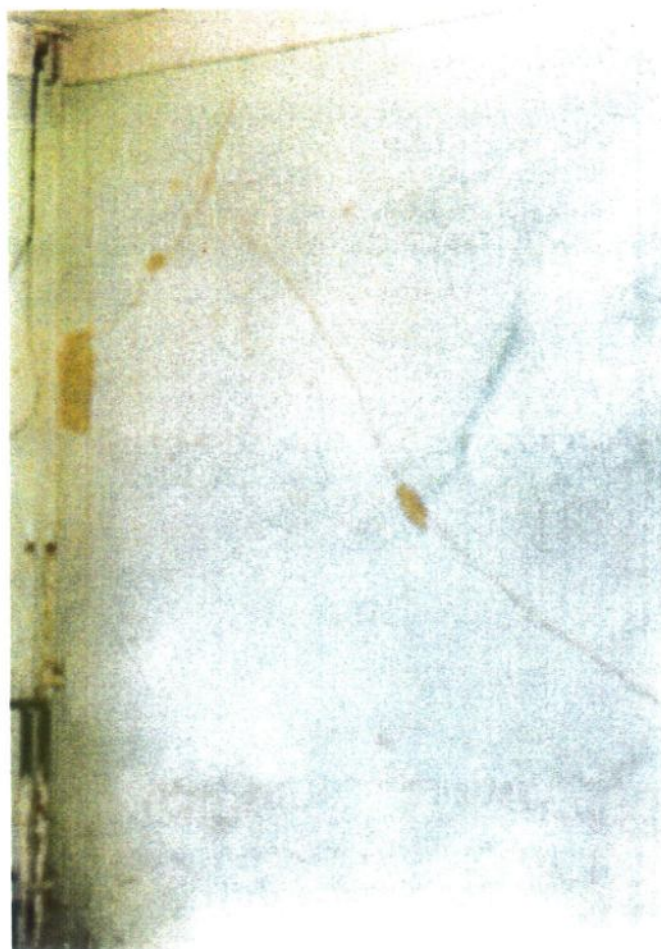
Fisuri înclinate în pereți prefabricați și fisuri la monolitizări.
